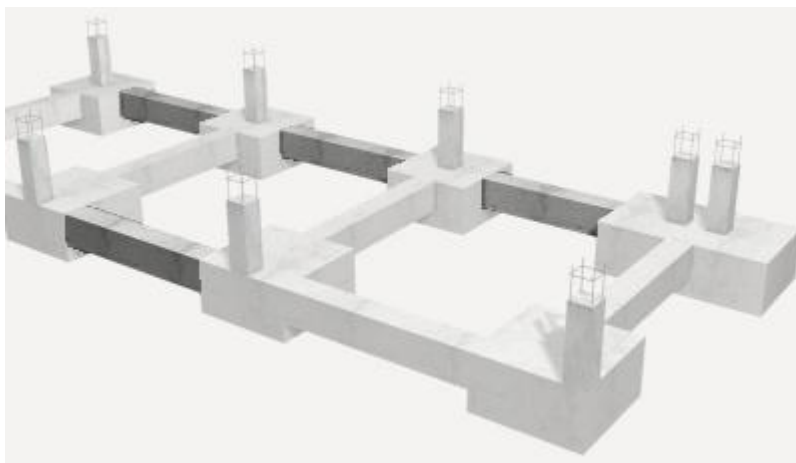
Sapatas agrupadas com viga de fundação [19].
